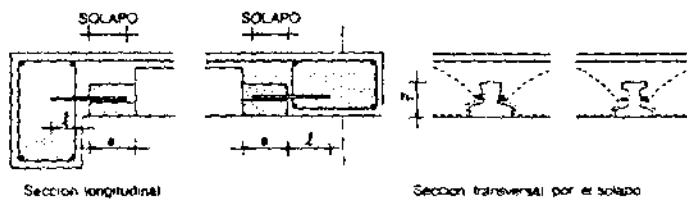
c SUSPENSIÓN DE VIGUETAS POR SOLAPO
